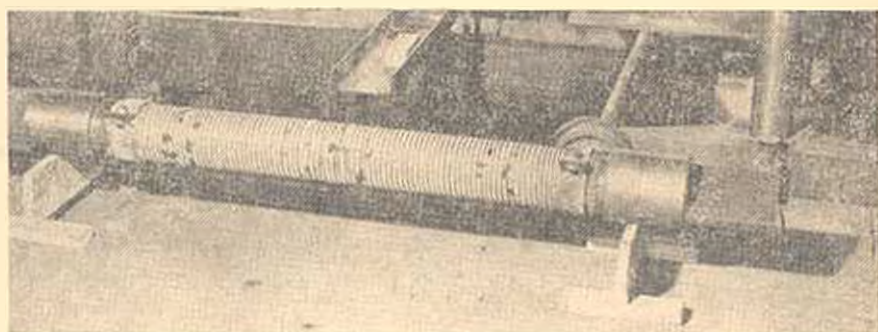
Образец с приспособлениями для закрепления в прессе.
